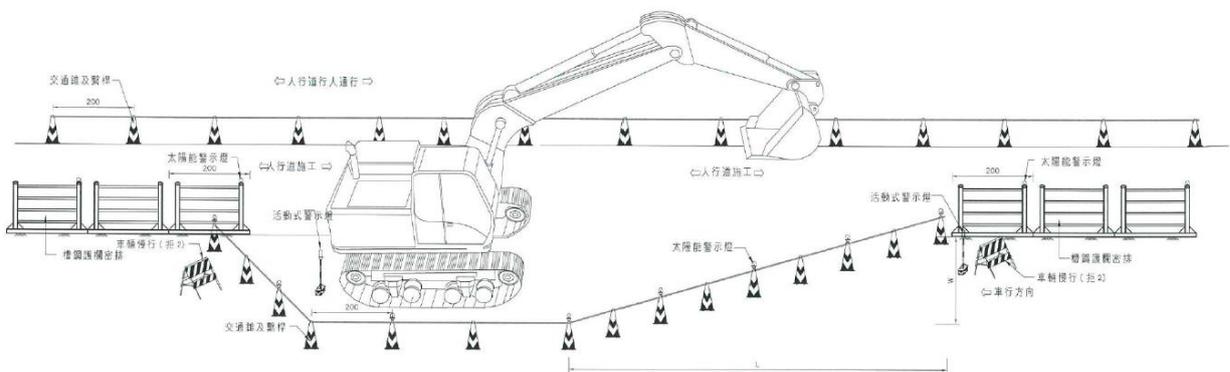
預計施工範圍之交通維持(機具施工中)示意圖
